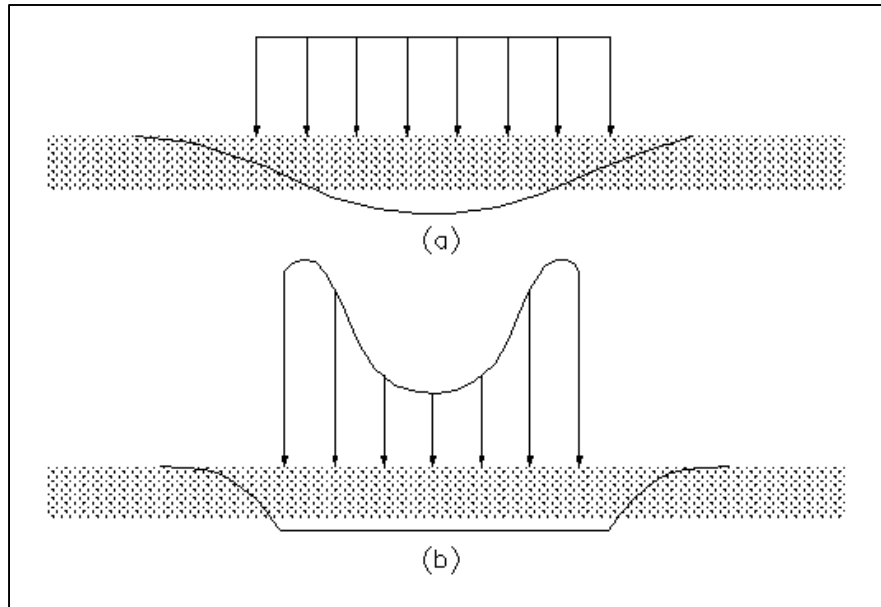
(a) Perfil de asentamiento para cimentaciones flexibles. (b) Perfil de asentamiento para cimentaciones rígidas.
